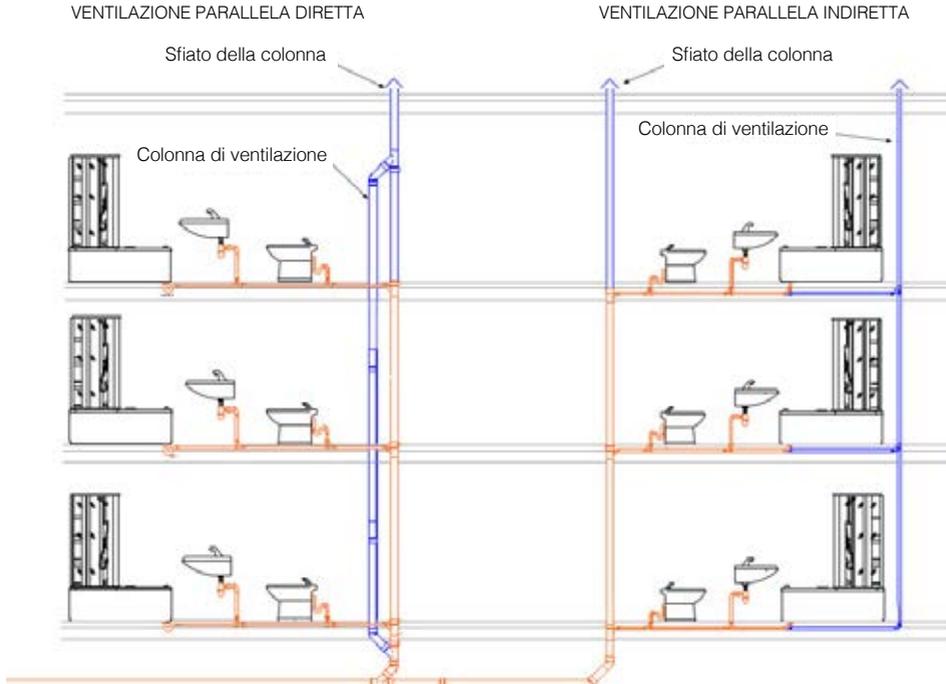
Schema sistema a ventilazione parallela diretta e indiretta
